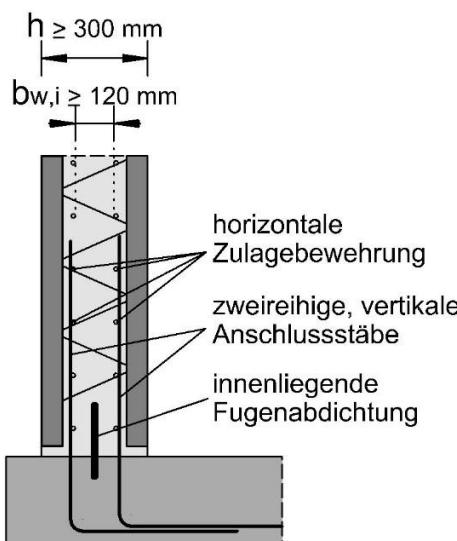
Elementwand mit Wanddicke von 300 mm und innenliegender Fugenabdichtung und Bewehrungslagen im Ortbeton mit dem Sonderfall horizontaler Bewehrungsstäbe
